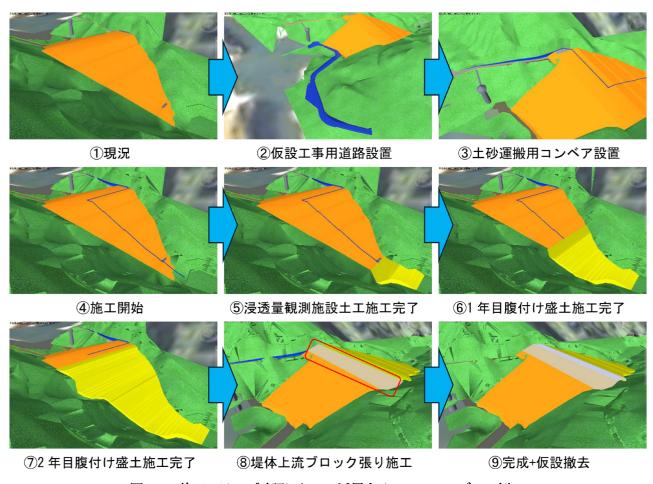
施工ステップ確認において活用するBIM/CIMモデルの例
